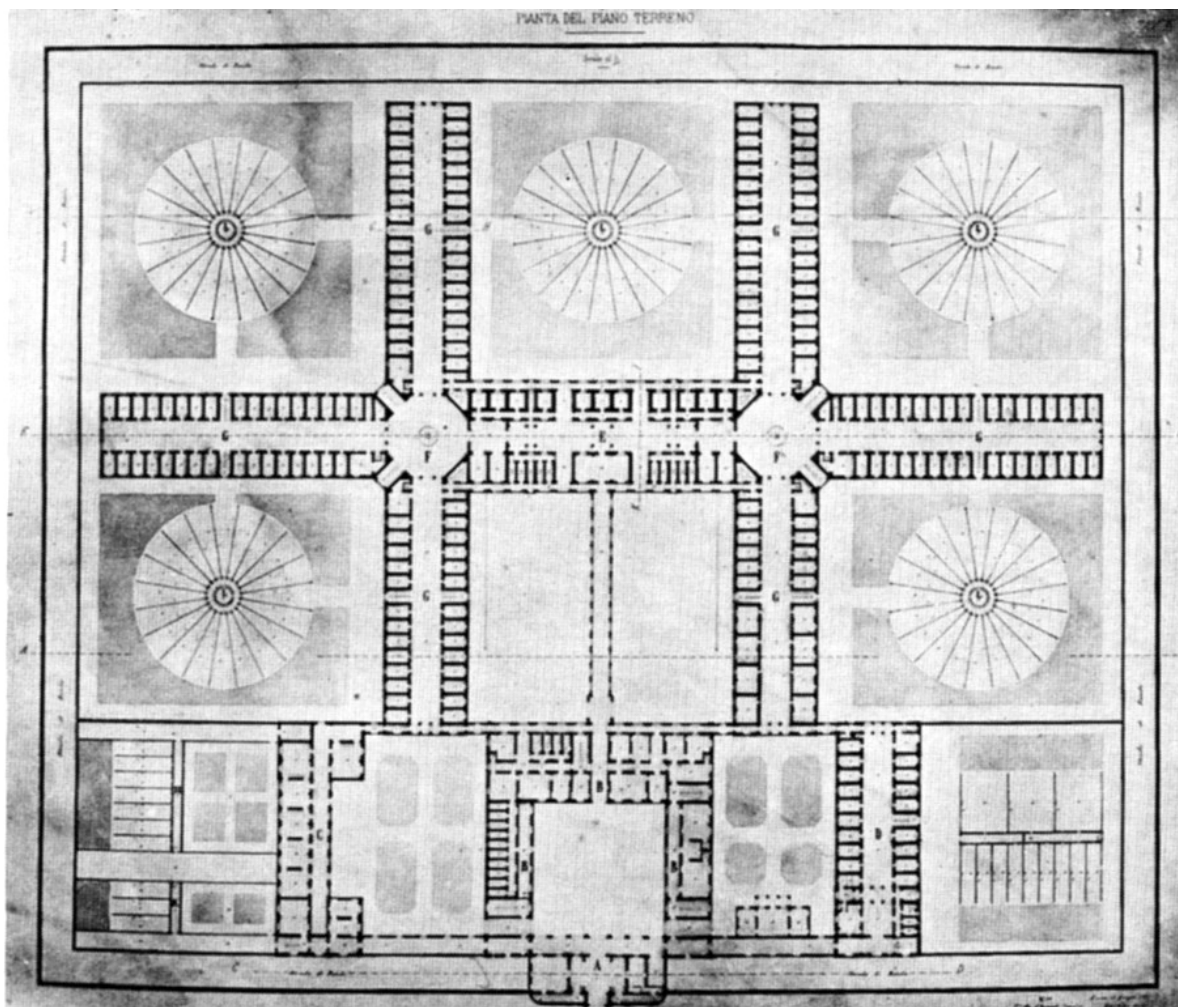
Giuseppe Polani, Progetto del carcere Le nuove, 1861. *Pianta piano terreno*. Archivio Storico della Città di Torino.
